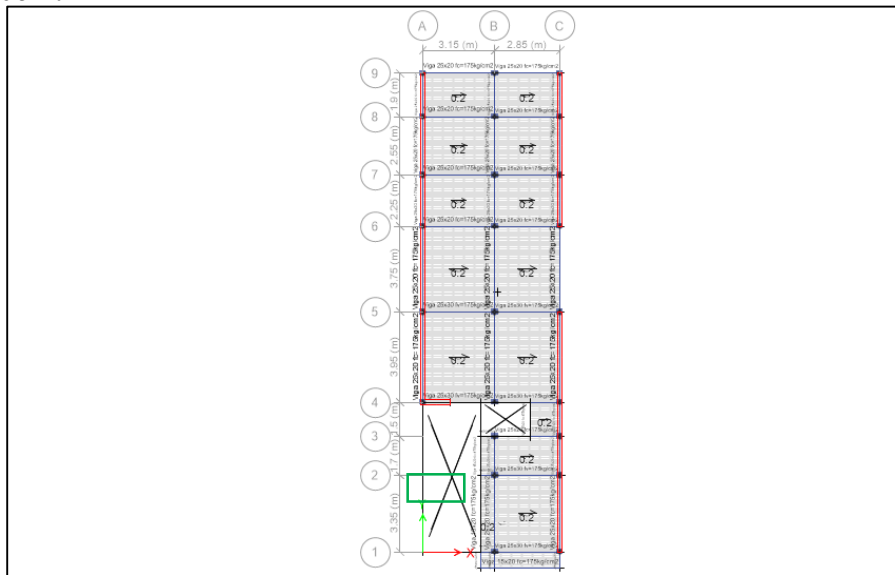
Vista en planta de la vivienda 2 reforzada con placa de concreto armado. Fuente: propia.
